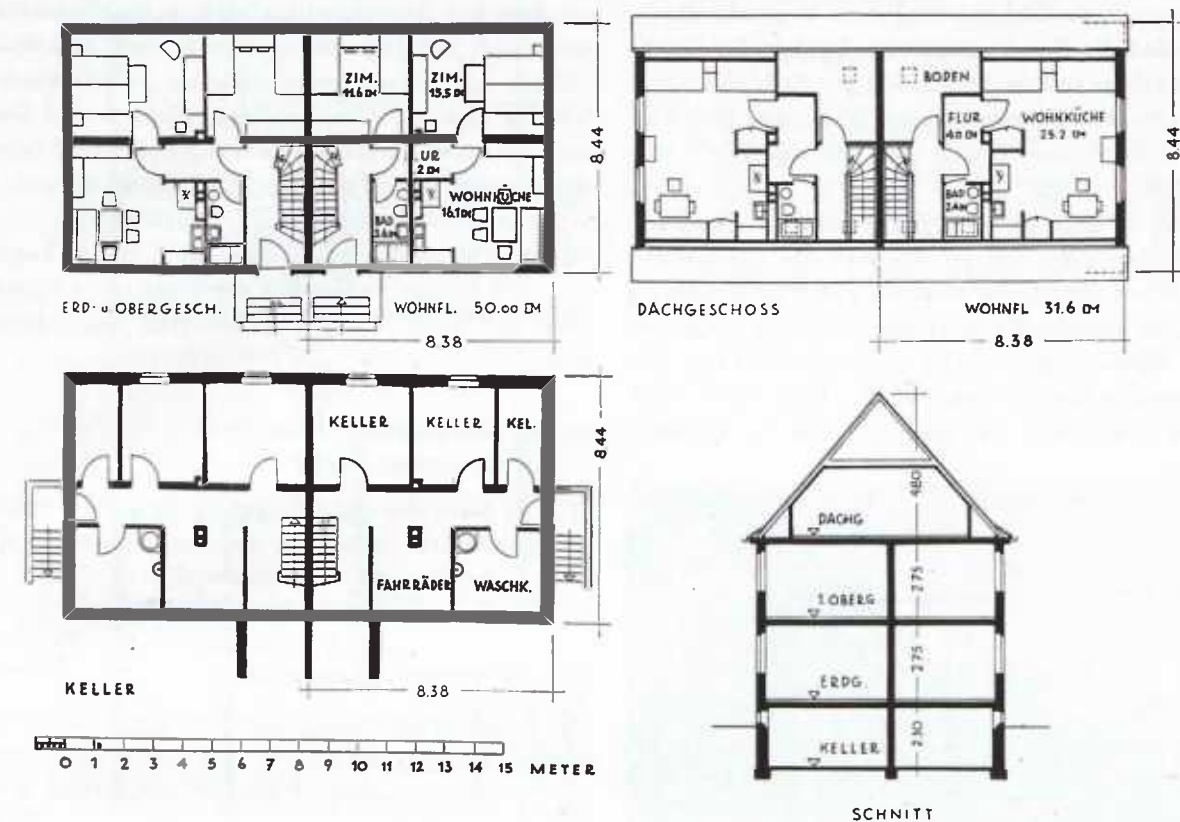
Versuchsbauten am Judensand. Einfamilien-Doppelhaus. Grundrisse und Schnitt
